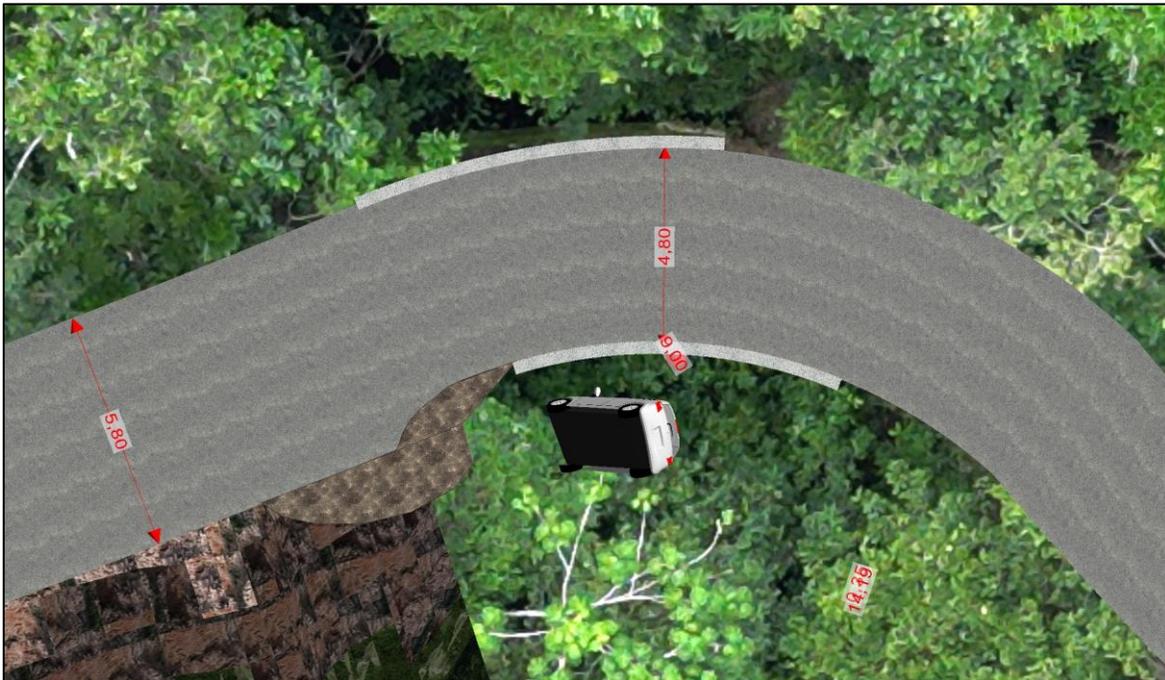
En esta imagen vista en planta se aprecian las características geométricas del tramo de vía donde ocurrió el accidente; nótese la posición final del automóvil.
